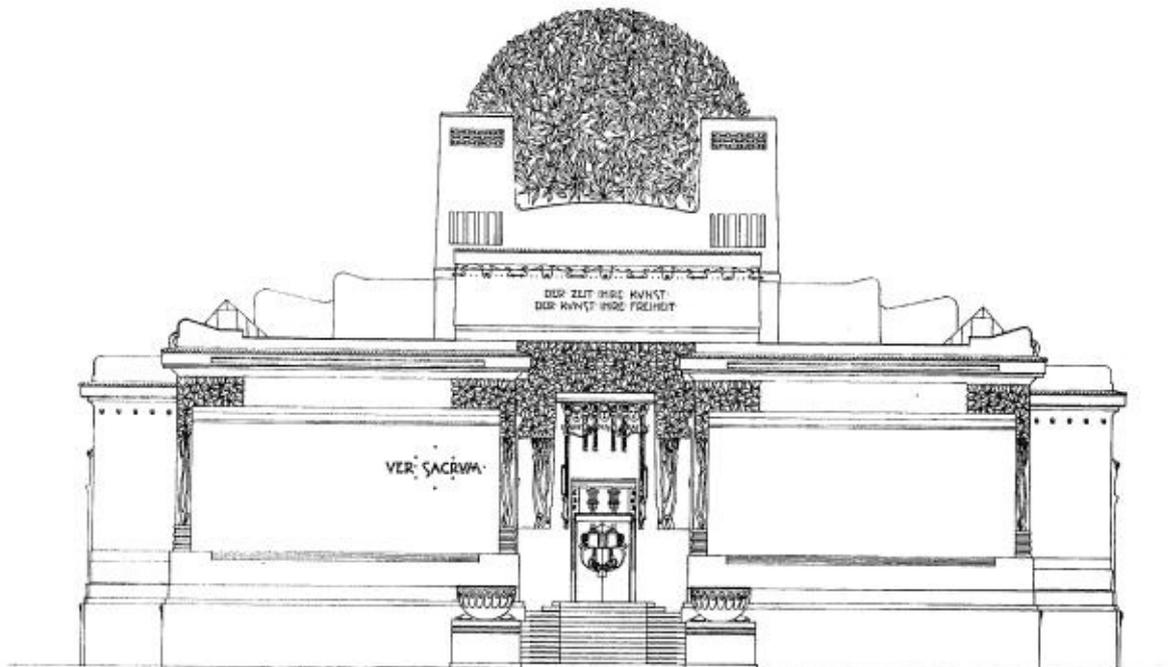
Plano del Alzado Frontal del edificio de la Seccion Vienesa. Josef M. Olbrich (1897)
